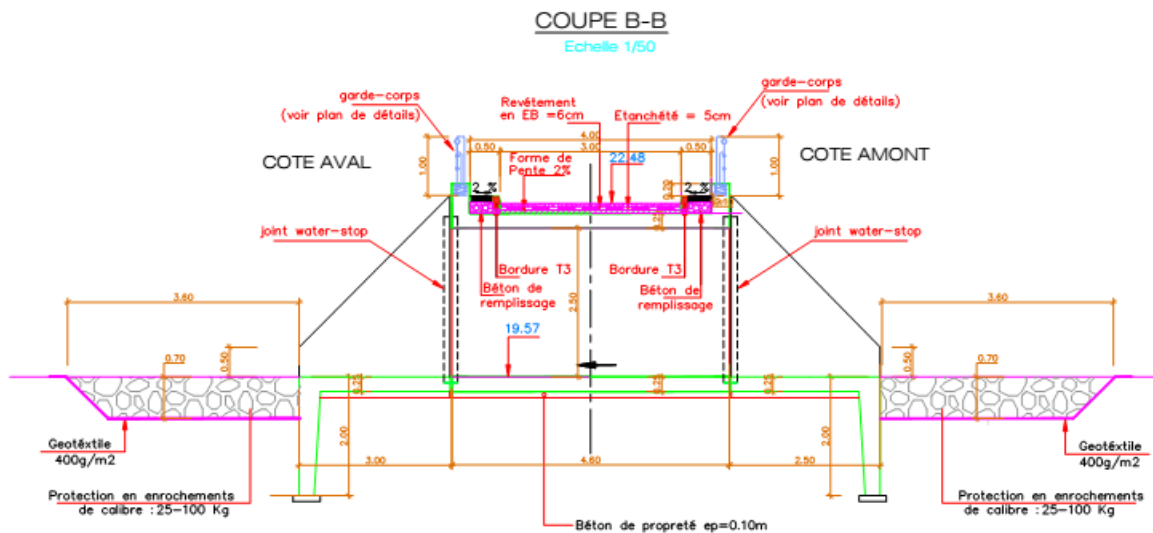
profil en long de l'ouvrage Hydraulique 3 (OH3)
